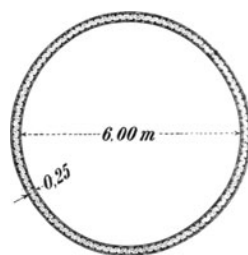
Eisenbewehrter Stampfbeton. (Zulässige Beanspruchung 30 kg/qcm.)
